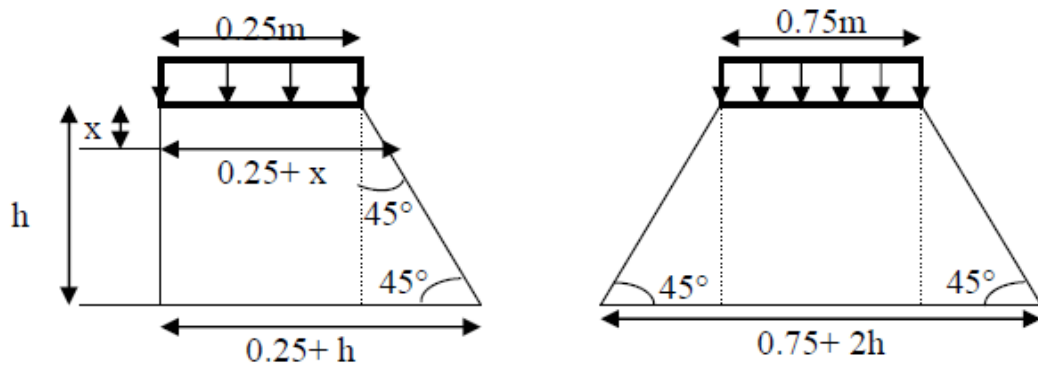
Poussée de la charge locale située en arrière du mur.
